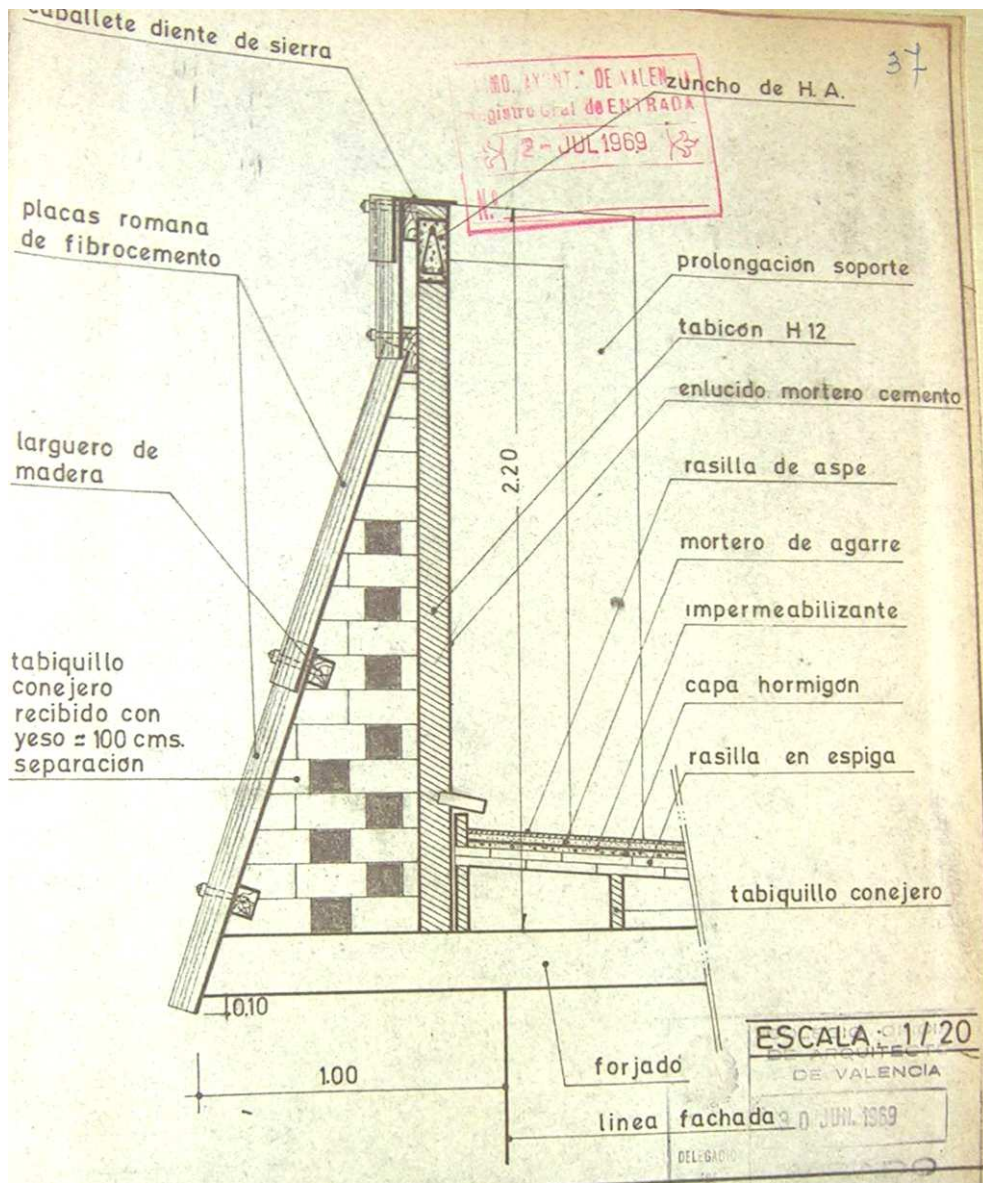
Detalle de antepecho cubierta. Edificio ficha 215C.015, 1969.
